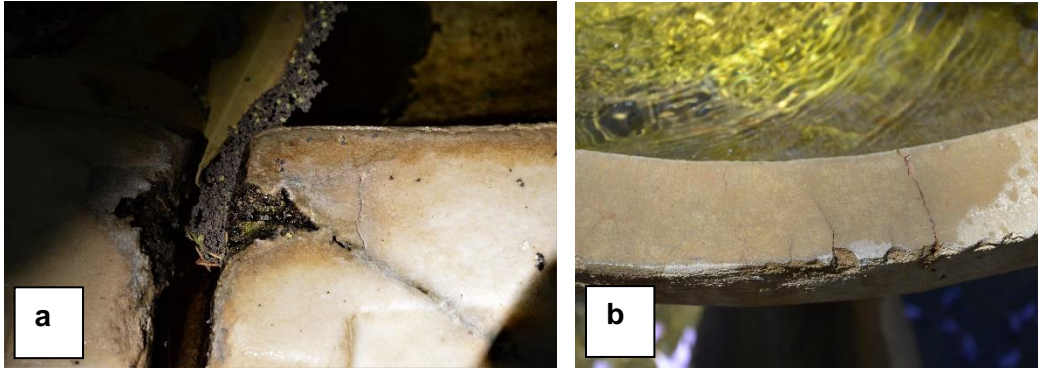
Fisuras en la piedra ornamental. (Calvo, 2019).
